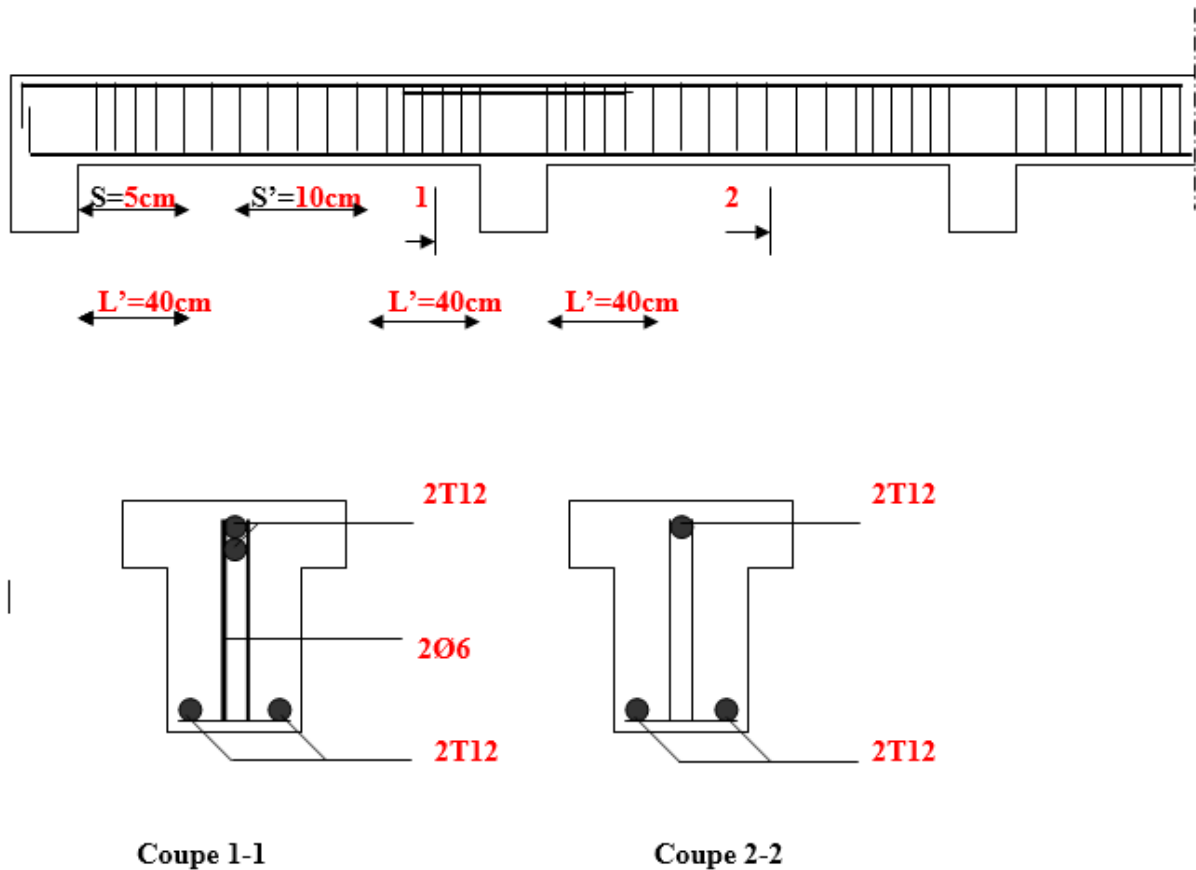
Schéma de ferrailage des poutrelles et coupes en travées (2-2) et sur appuis (1-1)
